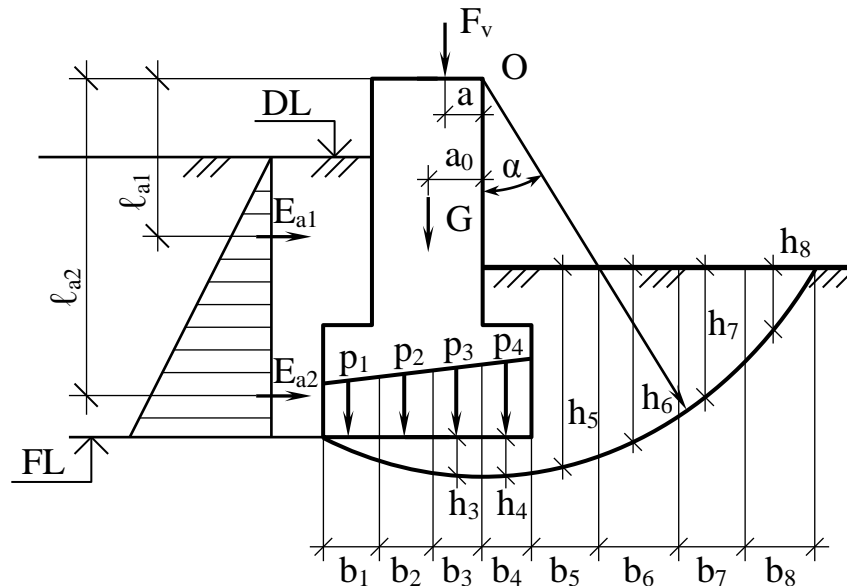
До розрахунку стійкості фундаменту з використанням схеми круглоциліндричної поверхні ковзання
